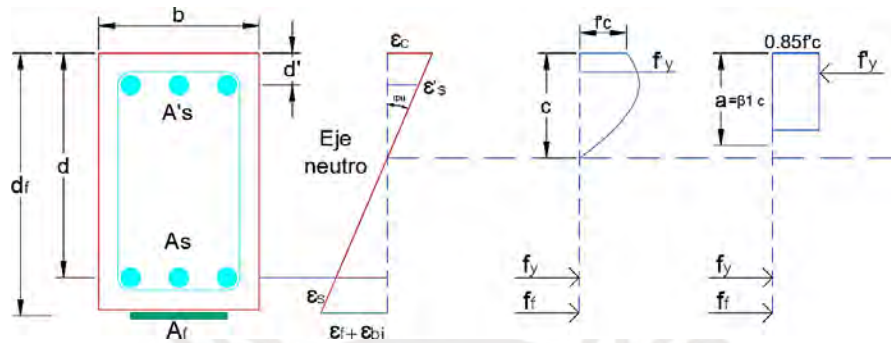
Viga de concreto armado reforzada con FRP, estado último.
